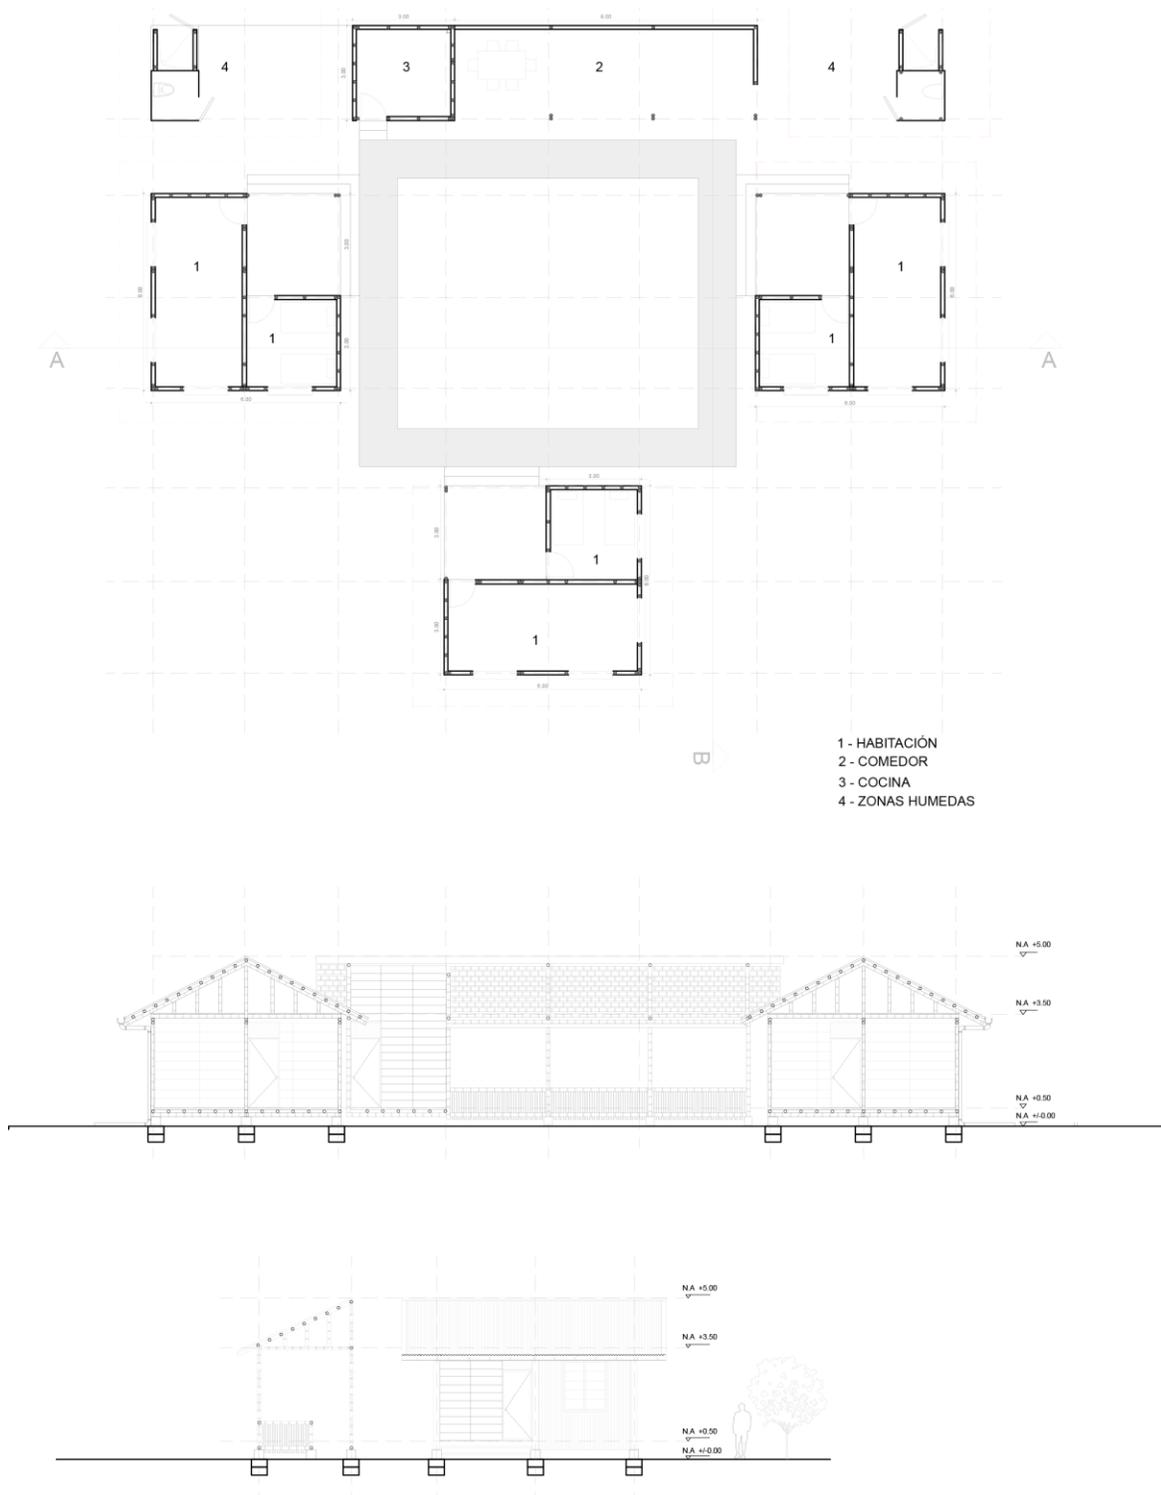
Planimetrías de la composición 4: vivienda en O. Fuente: autor.
